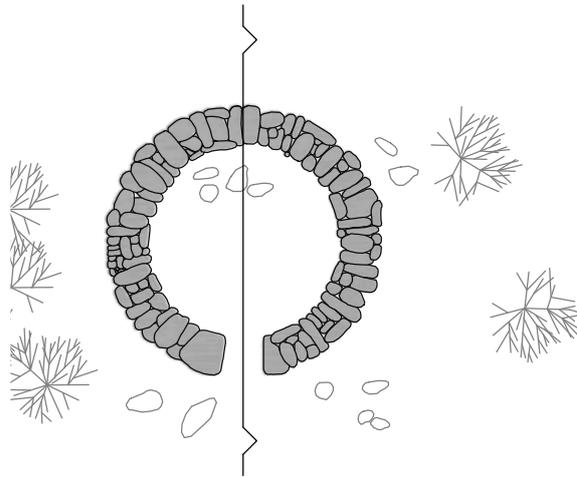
Planta del alzado de Gandullo en Bermillo de Sayago. Fuente: Elaboración propia.
